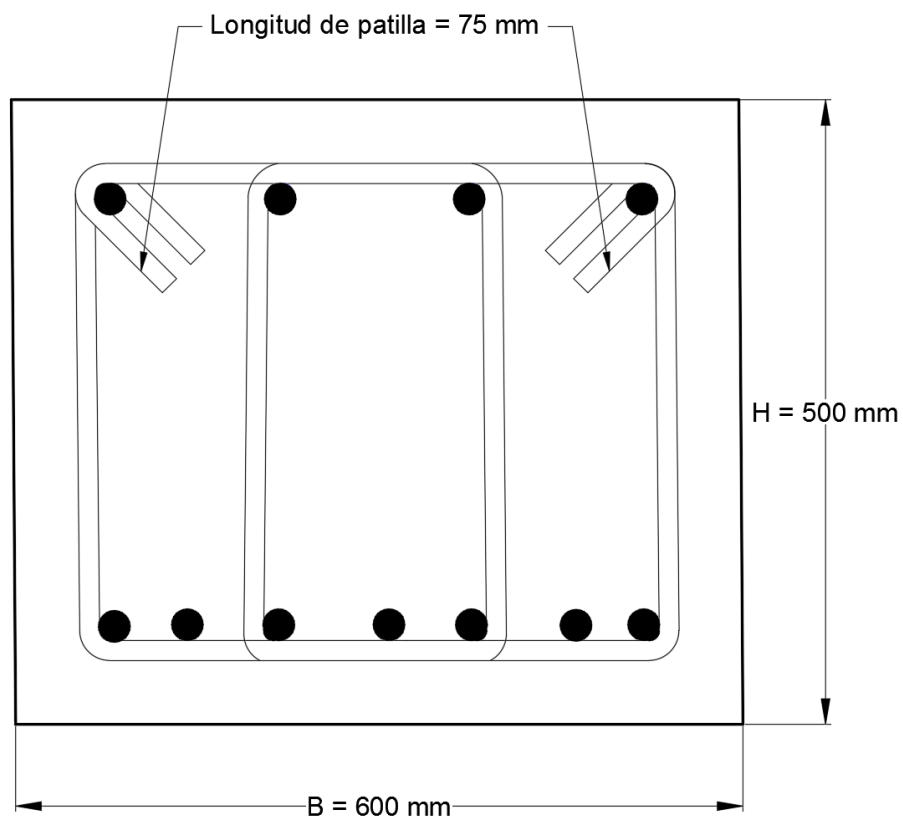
Detalle de la longitud de patilla en un armado genérico
